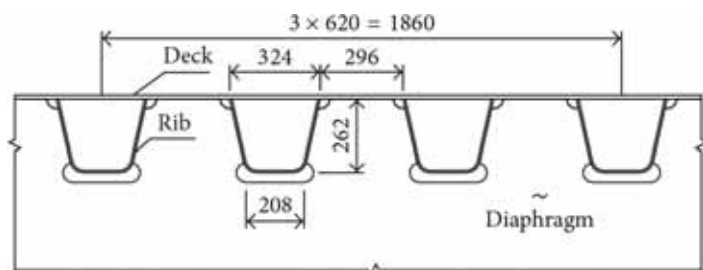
Dettagli del deck in acciaio a piastra ortotropa del HuMen Bridge (unità: mm).
